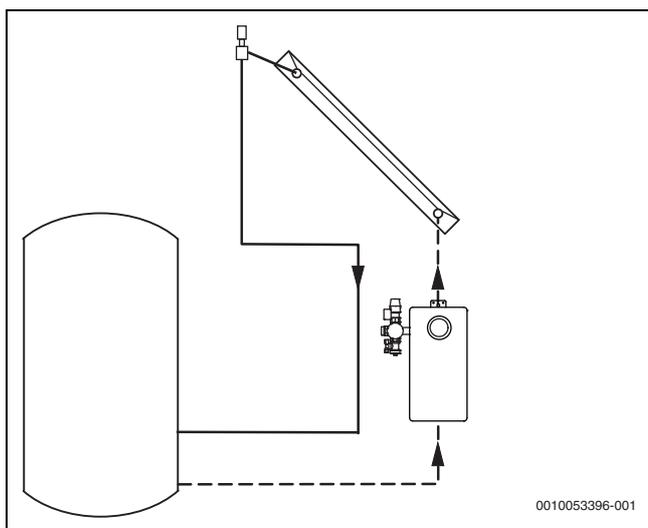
Système standard avec groupe de transfert monotube et purgeur en haut sur le toit
